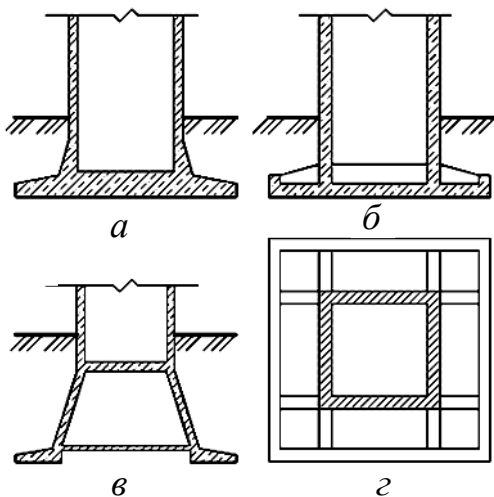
Плитні монолітні залізобетонні фундаменти під стовбури жорсткості будівель:
